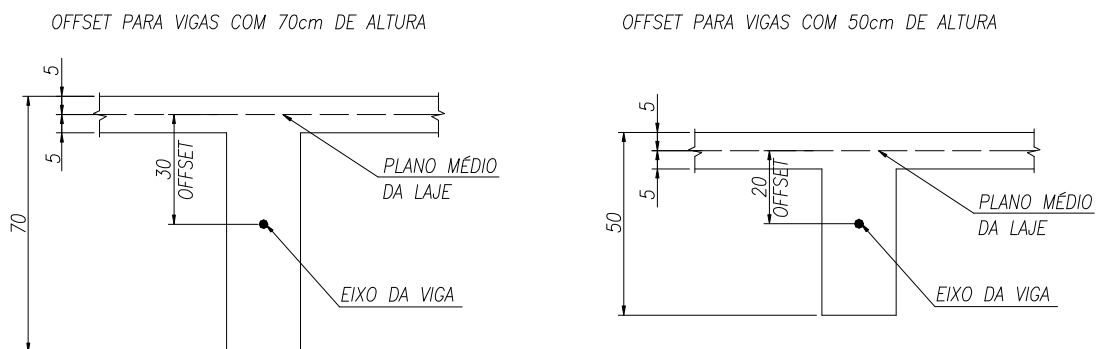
OFFSET nos Elementos de Barra das Vigas (Medidas em Centímetro)
